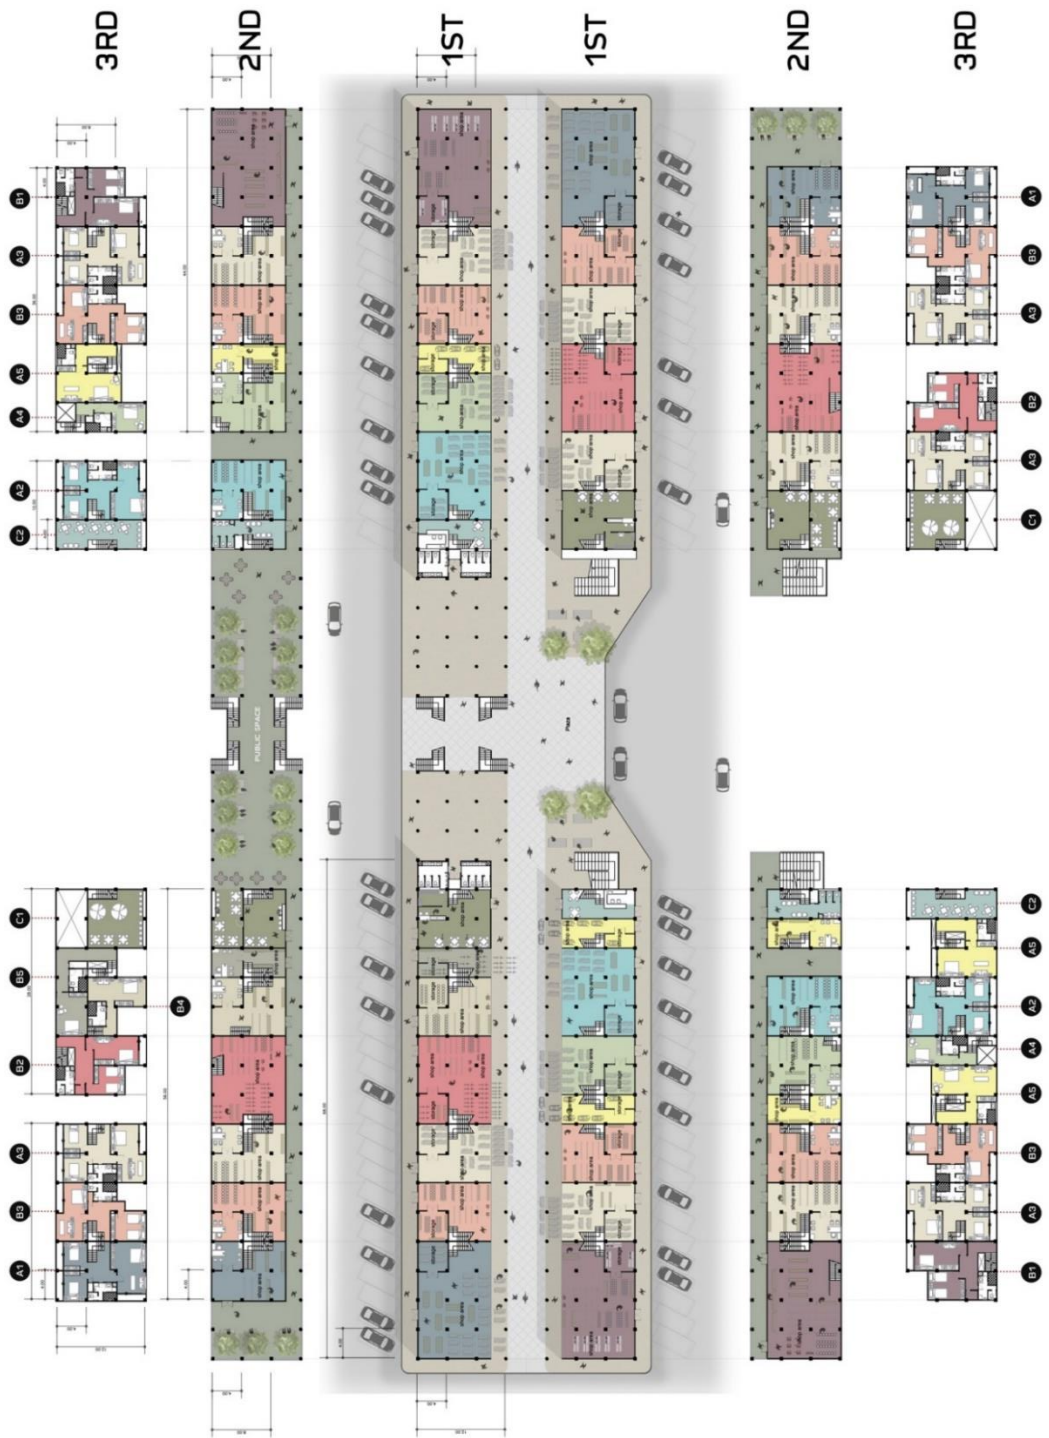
ภาพแสดง 2nd Floor Plan (Residential)
